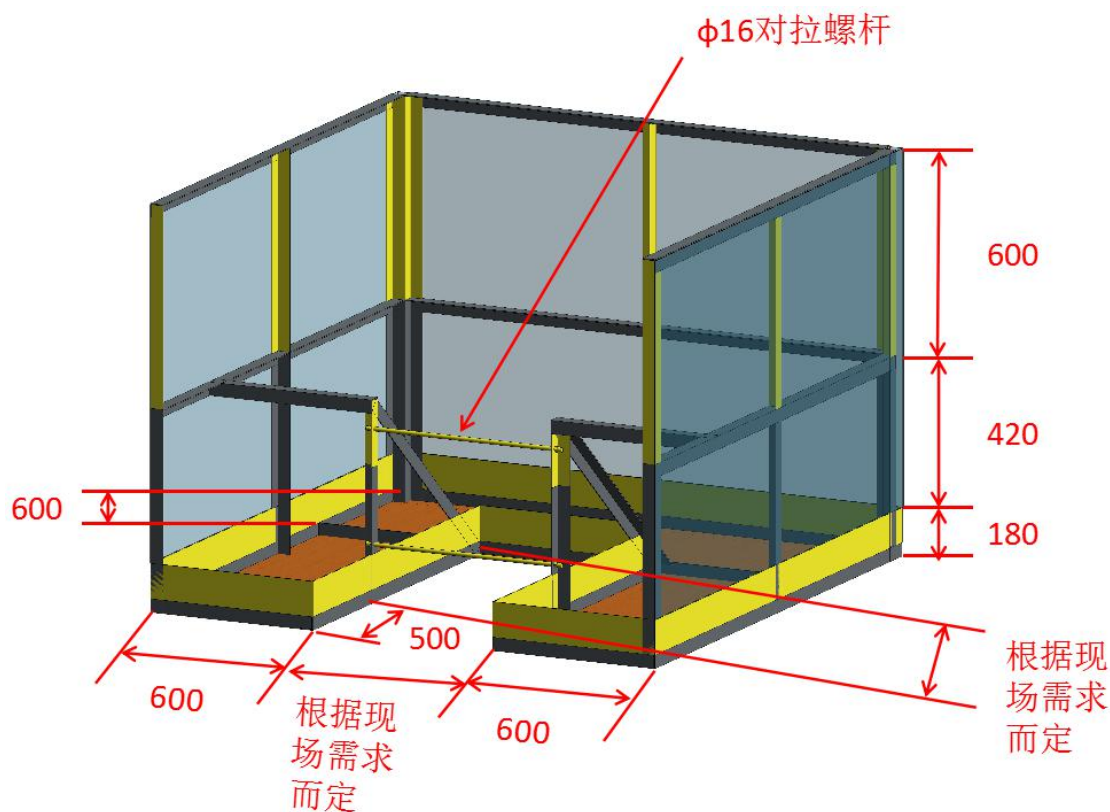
钢柱高处拼焊作业平台示意图
